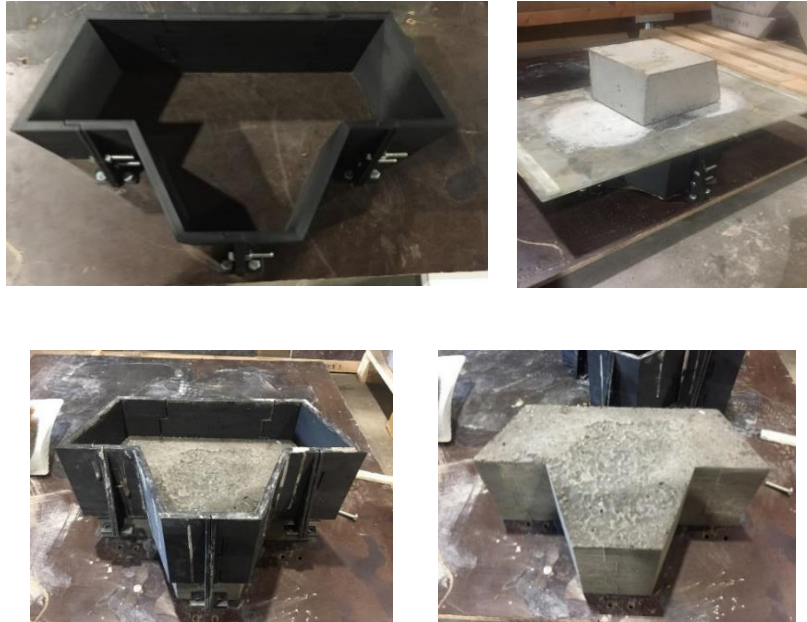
Pièces du moule modélisées sur SolidWorks et imprimées en 3D
